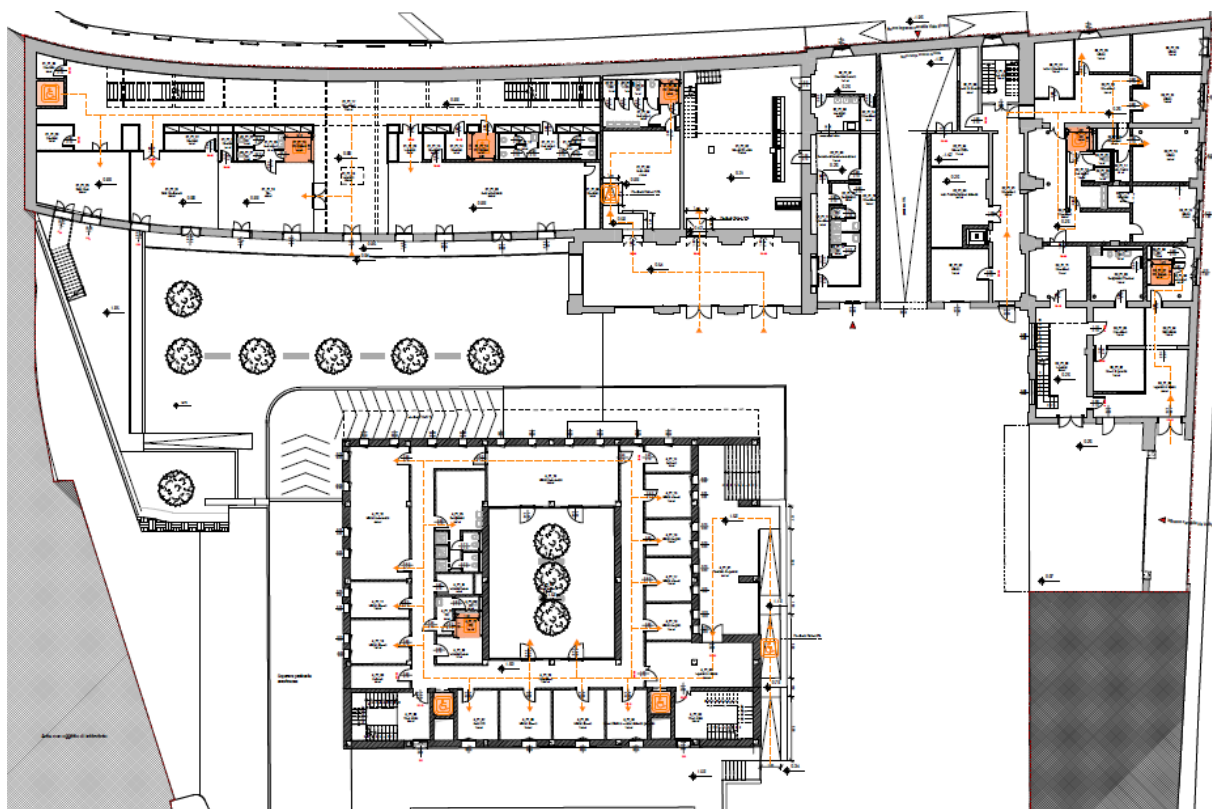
pianta piano terra rialzato - estratto della tavola dedicata al superamento delle barriere architettoniche
